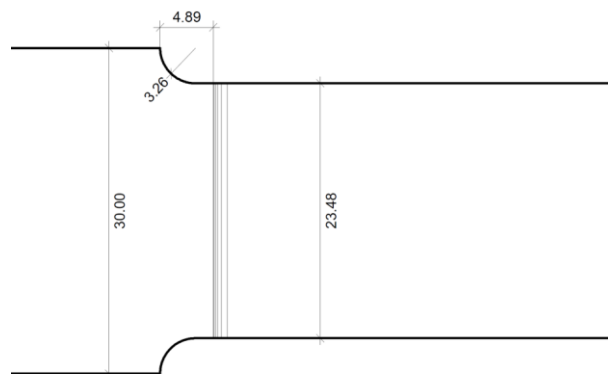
Schematischer Grundriss des Wehrfeldes mit Abmessungen in cm
